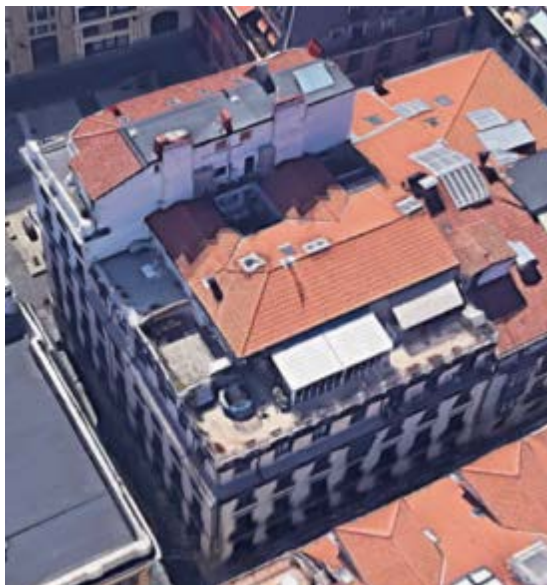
y 8. Ejemplos de conductos de extracción de humos adosados a fachadas exteriores
